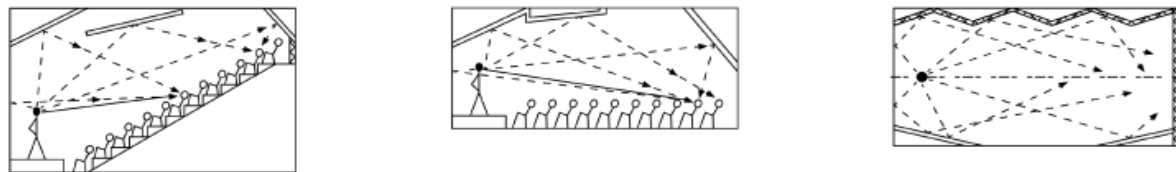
Nützliche Reflexionen für den hinteren Raumbereich (a und b Aufrisse, c Grundriss) (DIN 18041:2016-03 Bild 7)
